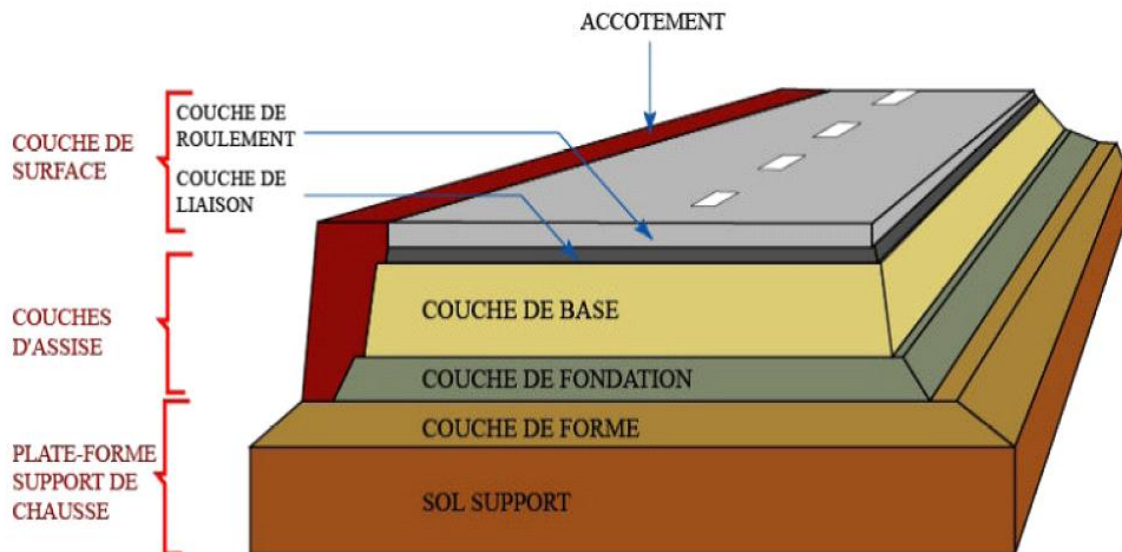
Coupe type d'une structure de chaussée et terminologie des différentes couches
